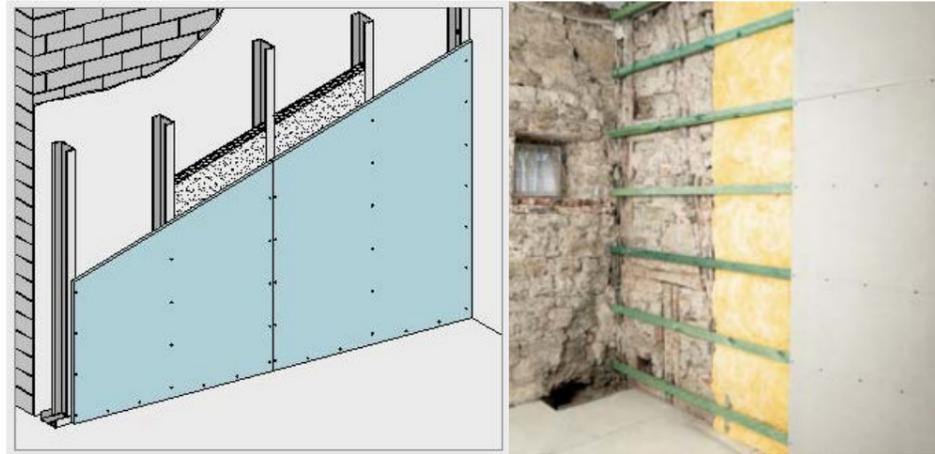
Detalle trasdosado autoportante KNAUF (Web Knauf)
